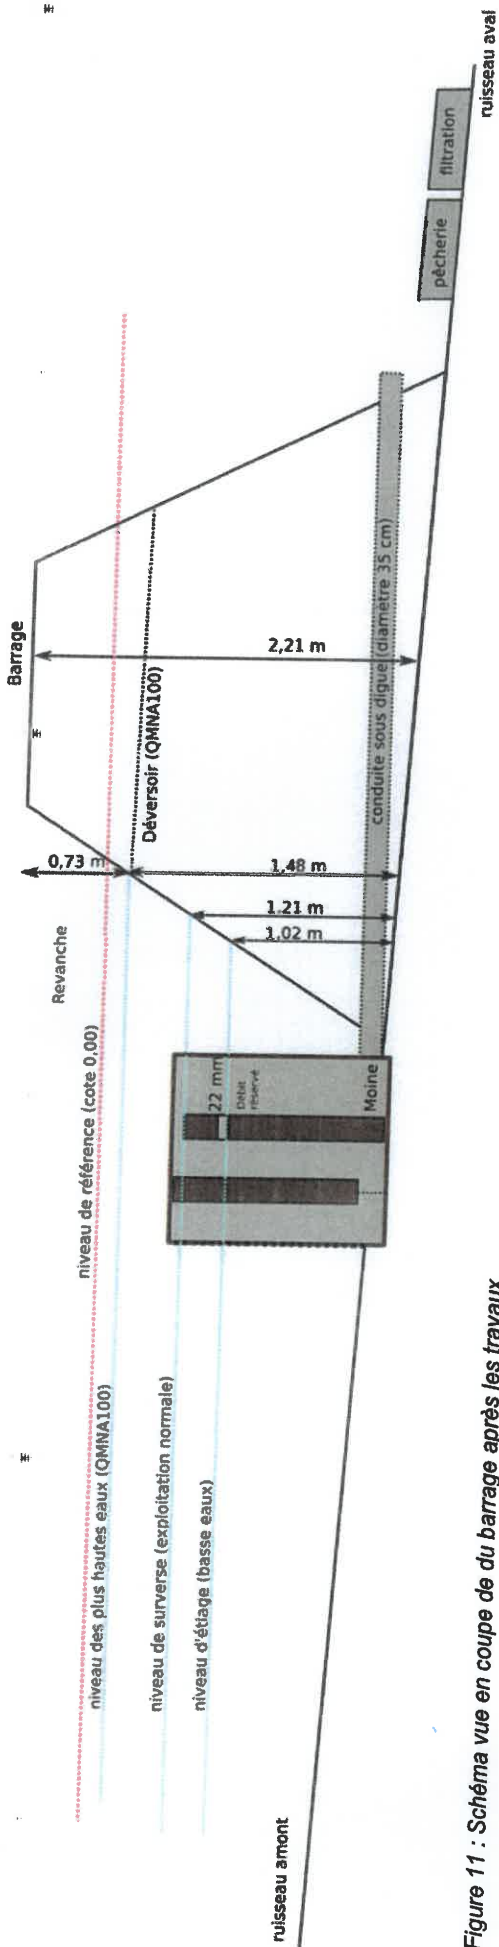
Schéma vue en coupe de du barrage après les travaux
